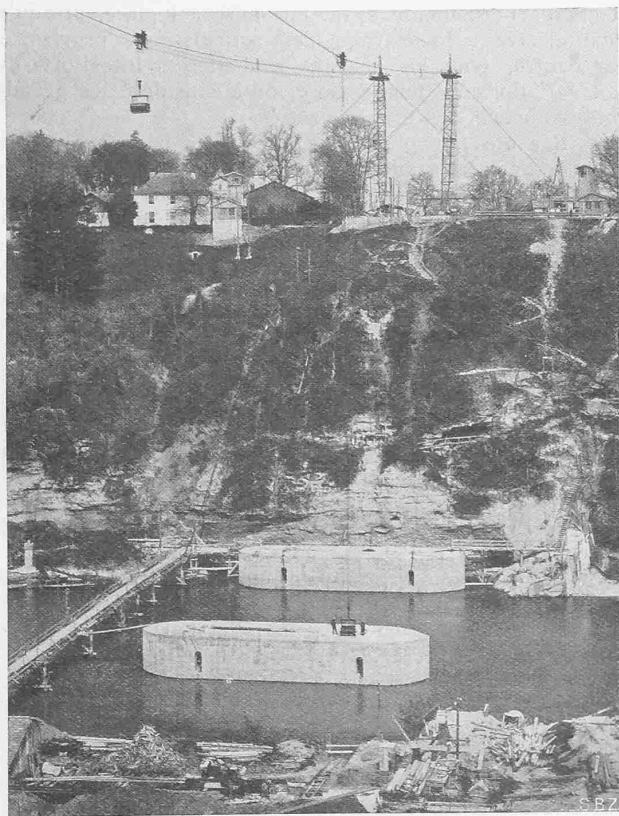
Rive droite, construction des piles I et II. 7 avril 1923.
